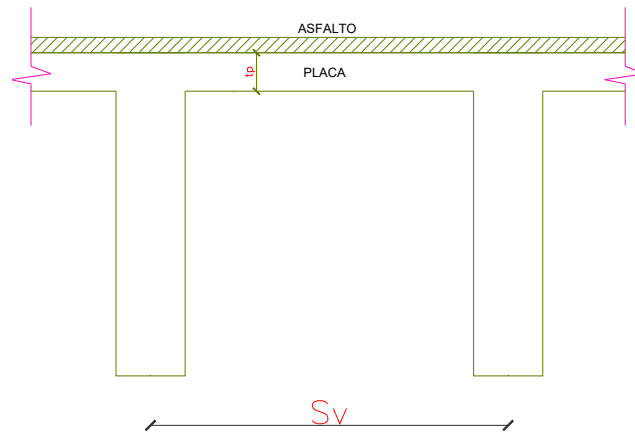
SECCIONES CARGA MUERTA PLACA ENTRE VIGAS. FUENTE: PROPIA
